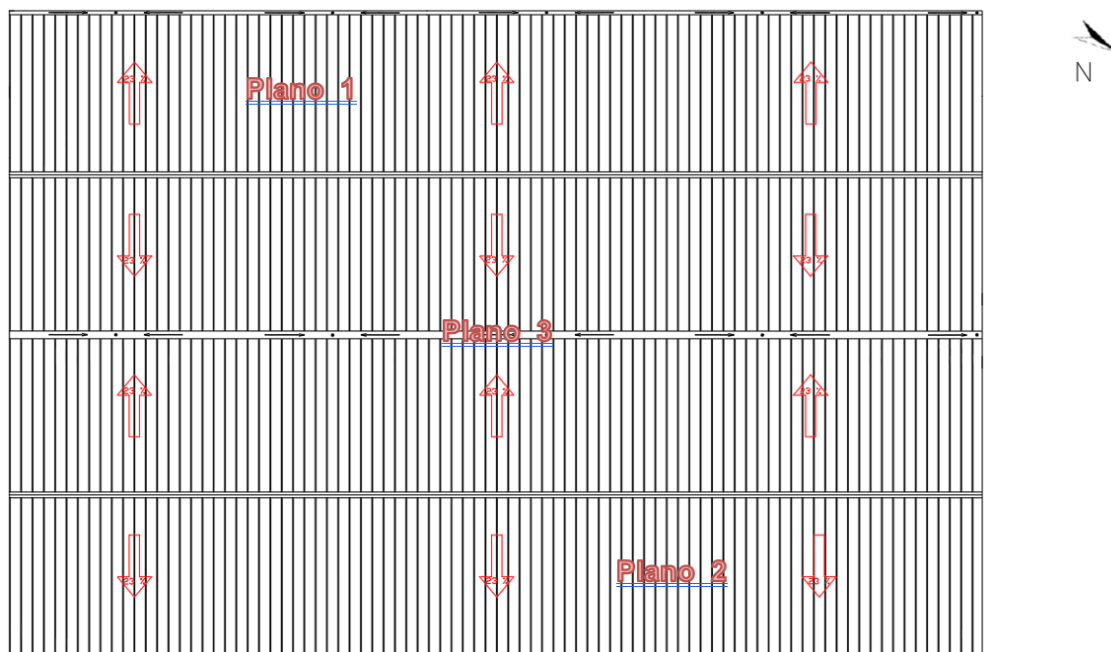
Planos en que se divide de la cubierta para el dimensionado de la red de saneamiento de aguas pluviales
